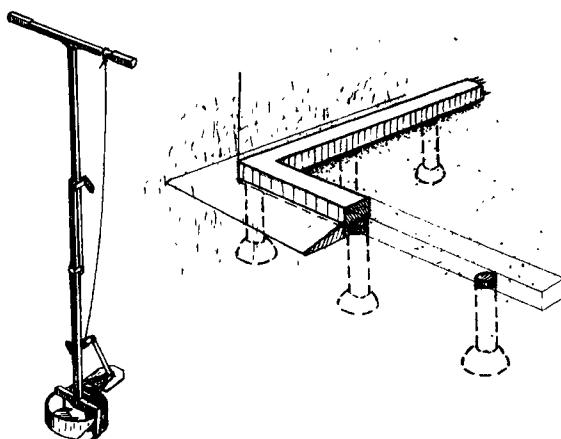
Фундаментный бур ТИСЭ-Ф и фундамент, выполненный с его помощью
